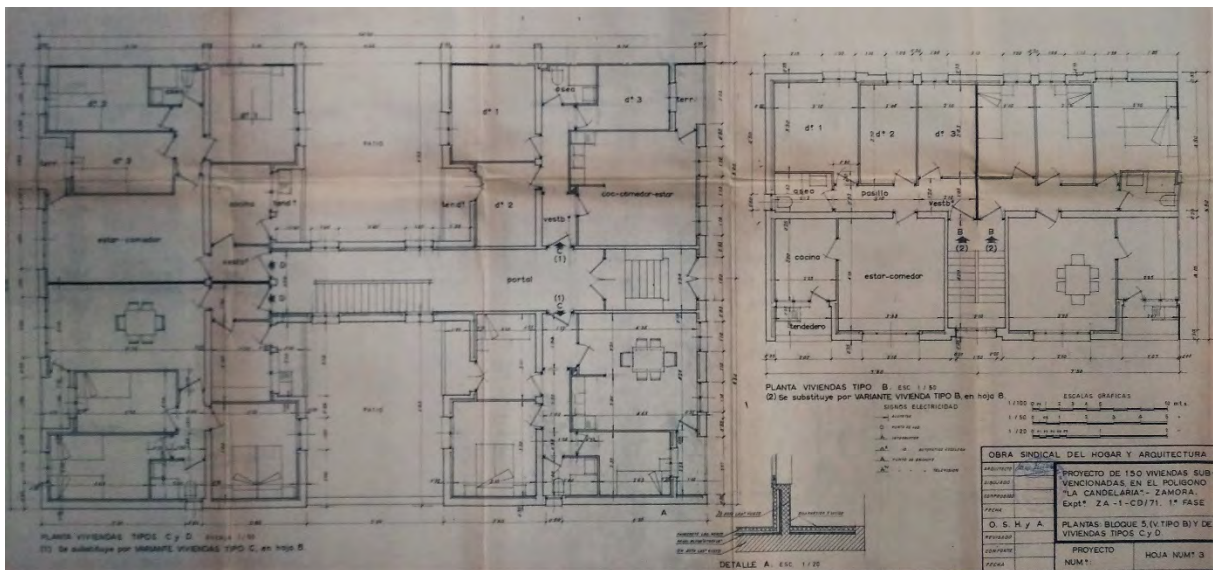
Plantas tipo B, C y D de la primera fase del grupo ZA-1-CD/71. Dacio Pinilla Olea (1969).
